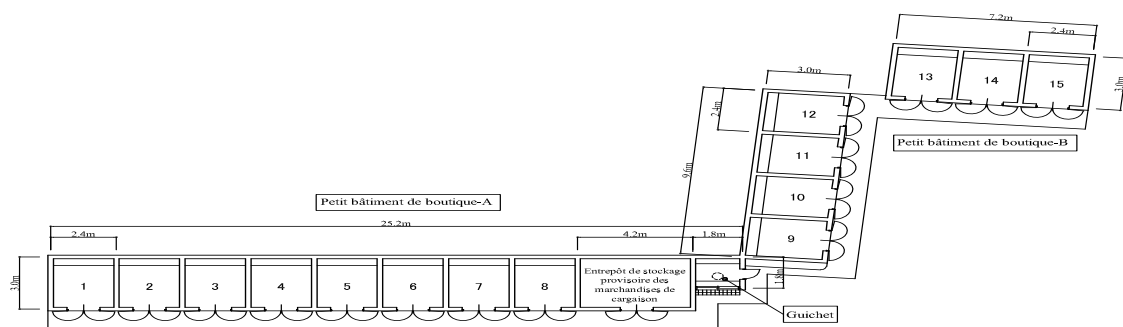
Plan de masse du petit bâtiment de boutique
